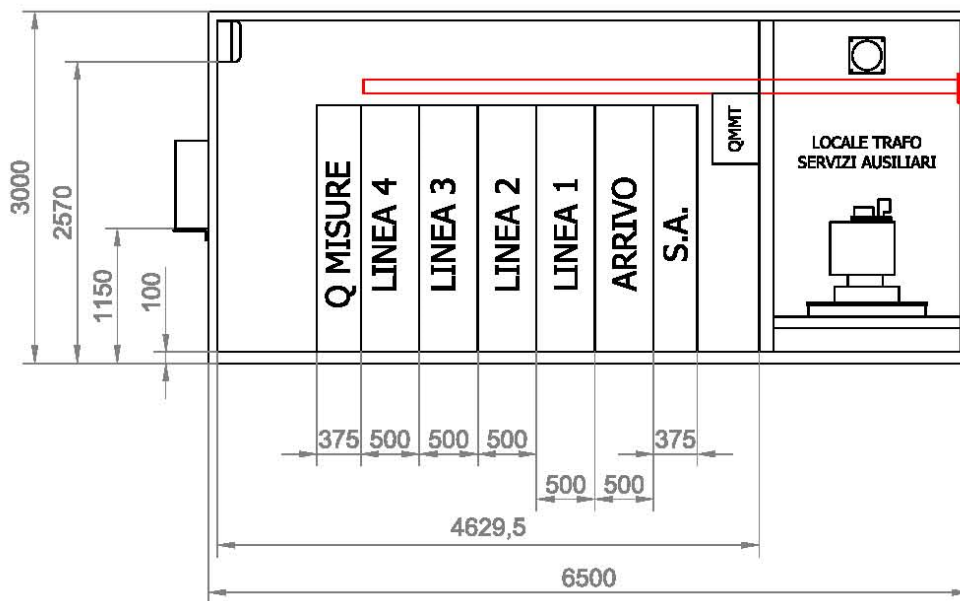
Prospetto locale AT in Cabina di Consegna utente
